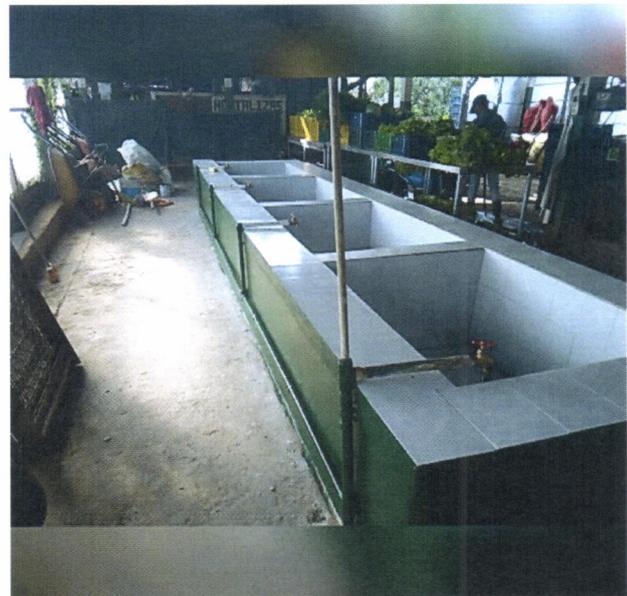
Modificación y arreglos de la pila de lavado para hortalizas.
